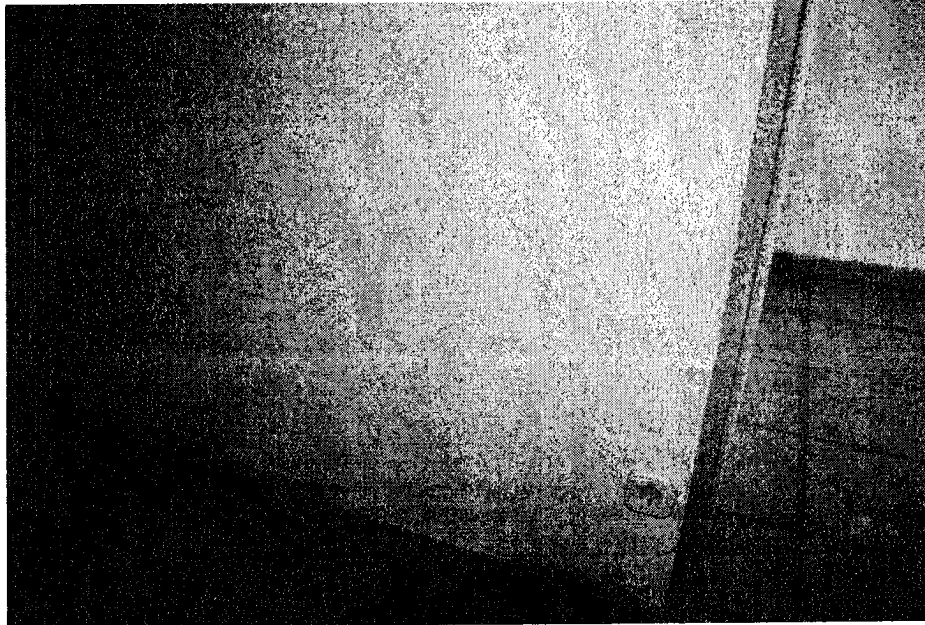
Erdgeschoss Eltern-Schlafzimmer, fehlende Sockelleisten
